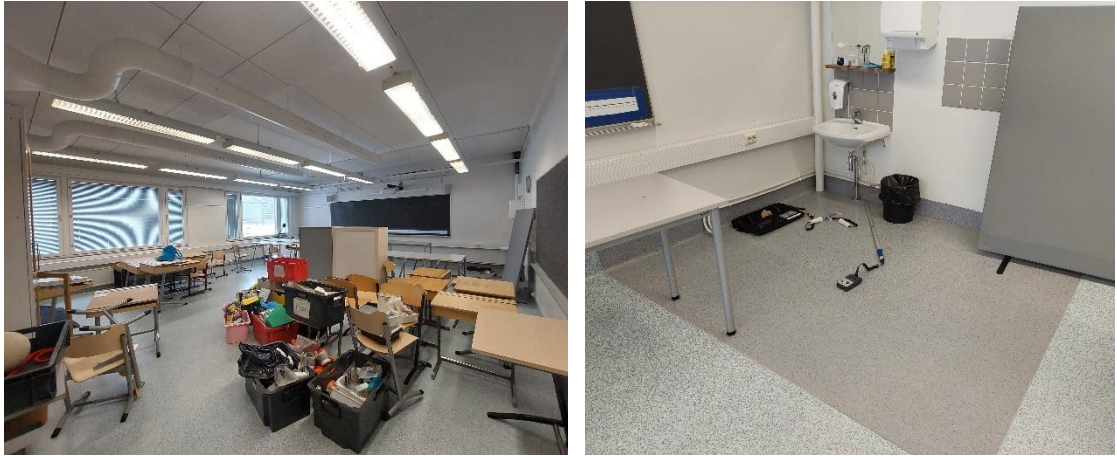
a ja b. Tilassa 228 ei havaittu poikkeavia hajuja tai muuta heikkoon sisäilman laatuun viittaavaa. Tilassa on järjestelmäalakatto, joissa levyjen reunassa on avointa mineraalivillapintaa. Alakaton yläpuolelta oli näkyvissä ulkoseinän ja yläpohjan liittymän tiivistykset, jotka olivat silmämääräisesti arvioituna hyvin tehtyjä.
